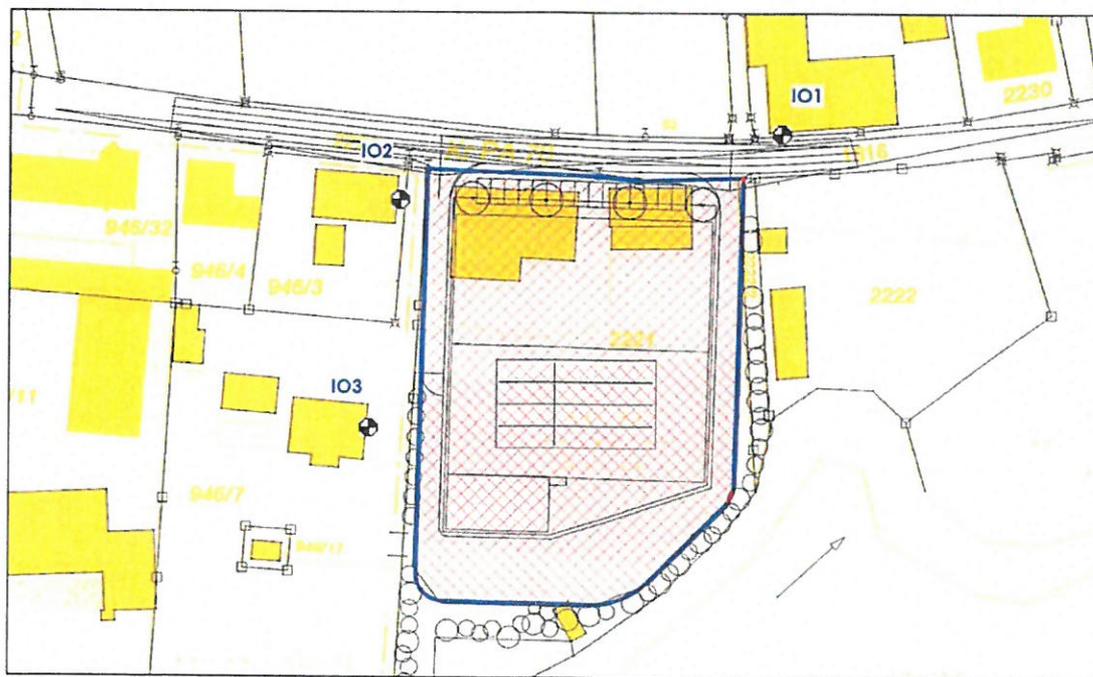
Lageplan mit Eintragung der maßgeblichen Immissionsorte IO
